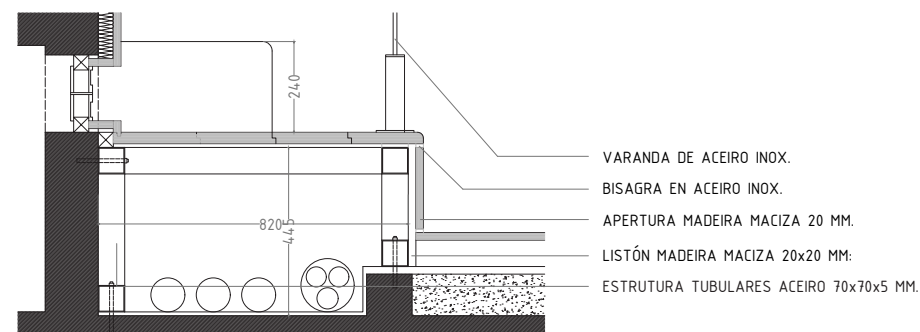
Detalle da caixa rexistrable baixo a bancada para o paso de instalacións. Escala 1/20
